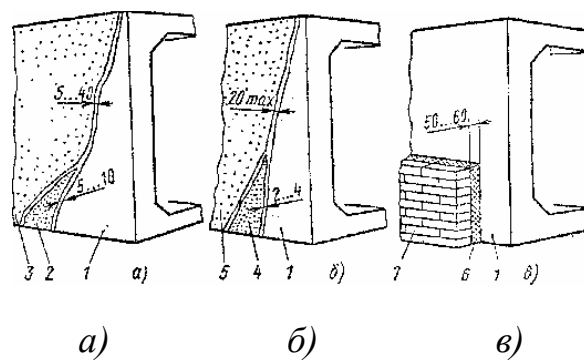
Гідроізоляція зовнішньої поверхні підземного залізобетонного тунелю:
